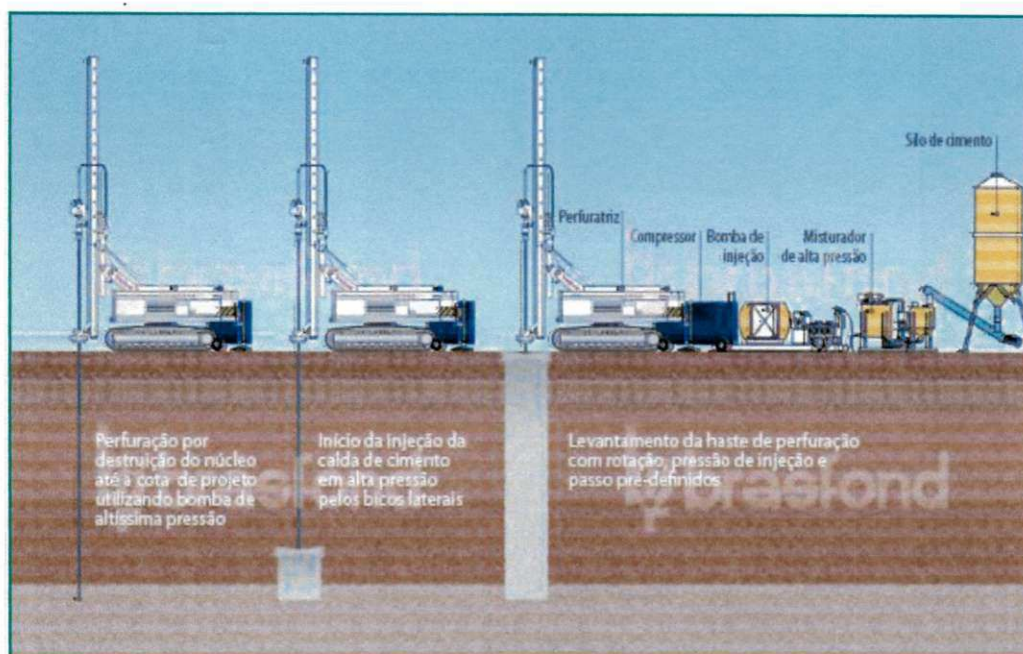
Processo de execução do *Compaction Grouting* (Brasfond, 2010)
